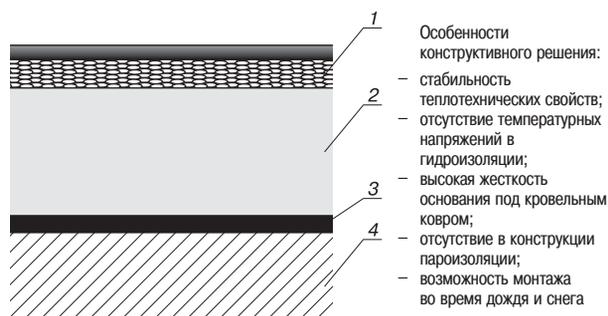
Схема устройства плоской инверсионной крыши\*: 1 – дренажно-распределительные слои; 2 – экструдированный пенополистирол URSA XPS; 3 – гидроизоляция; 4 – железобетонное покрытие
